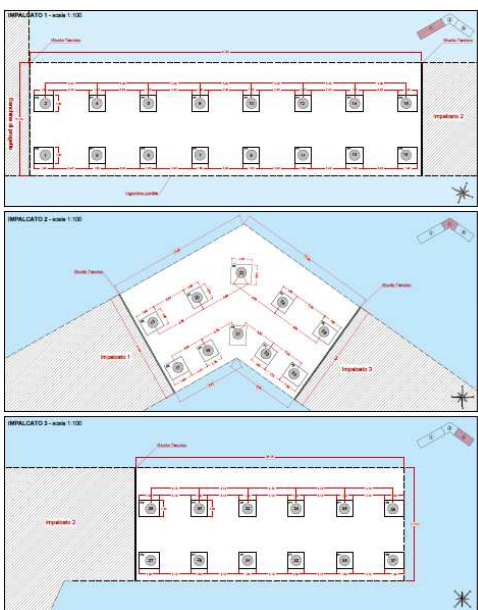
Planimetria disposizione pali e pulvini pontile. Da elab. prog. 06.
